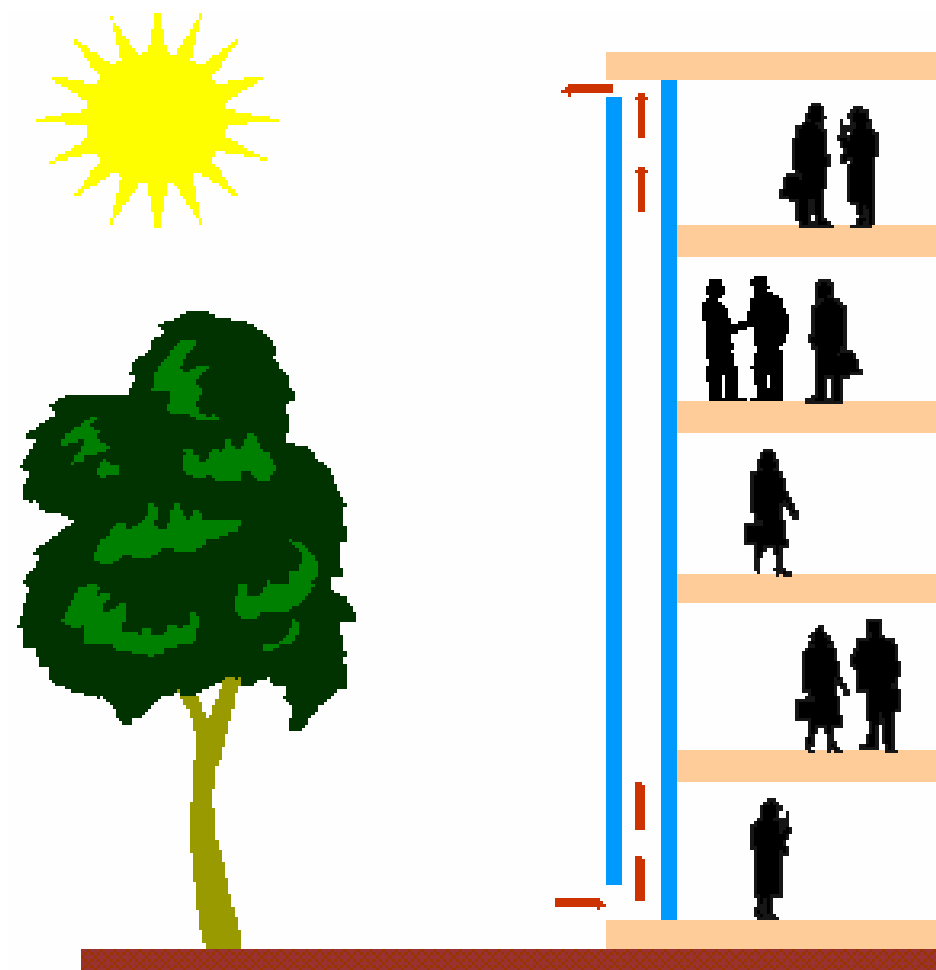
Funcionamento da câmara de ar em uma fachada ventilada.
